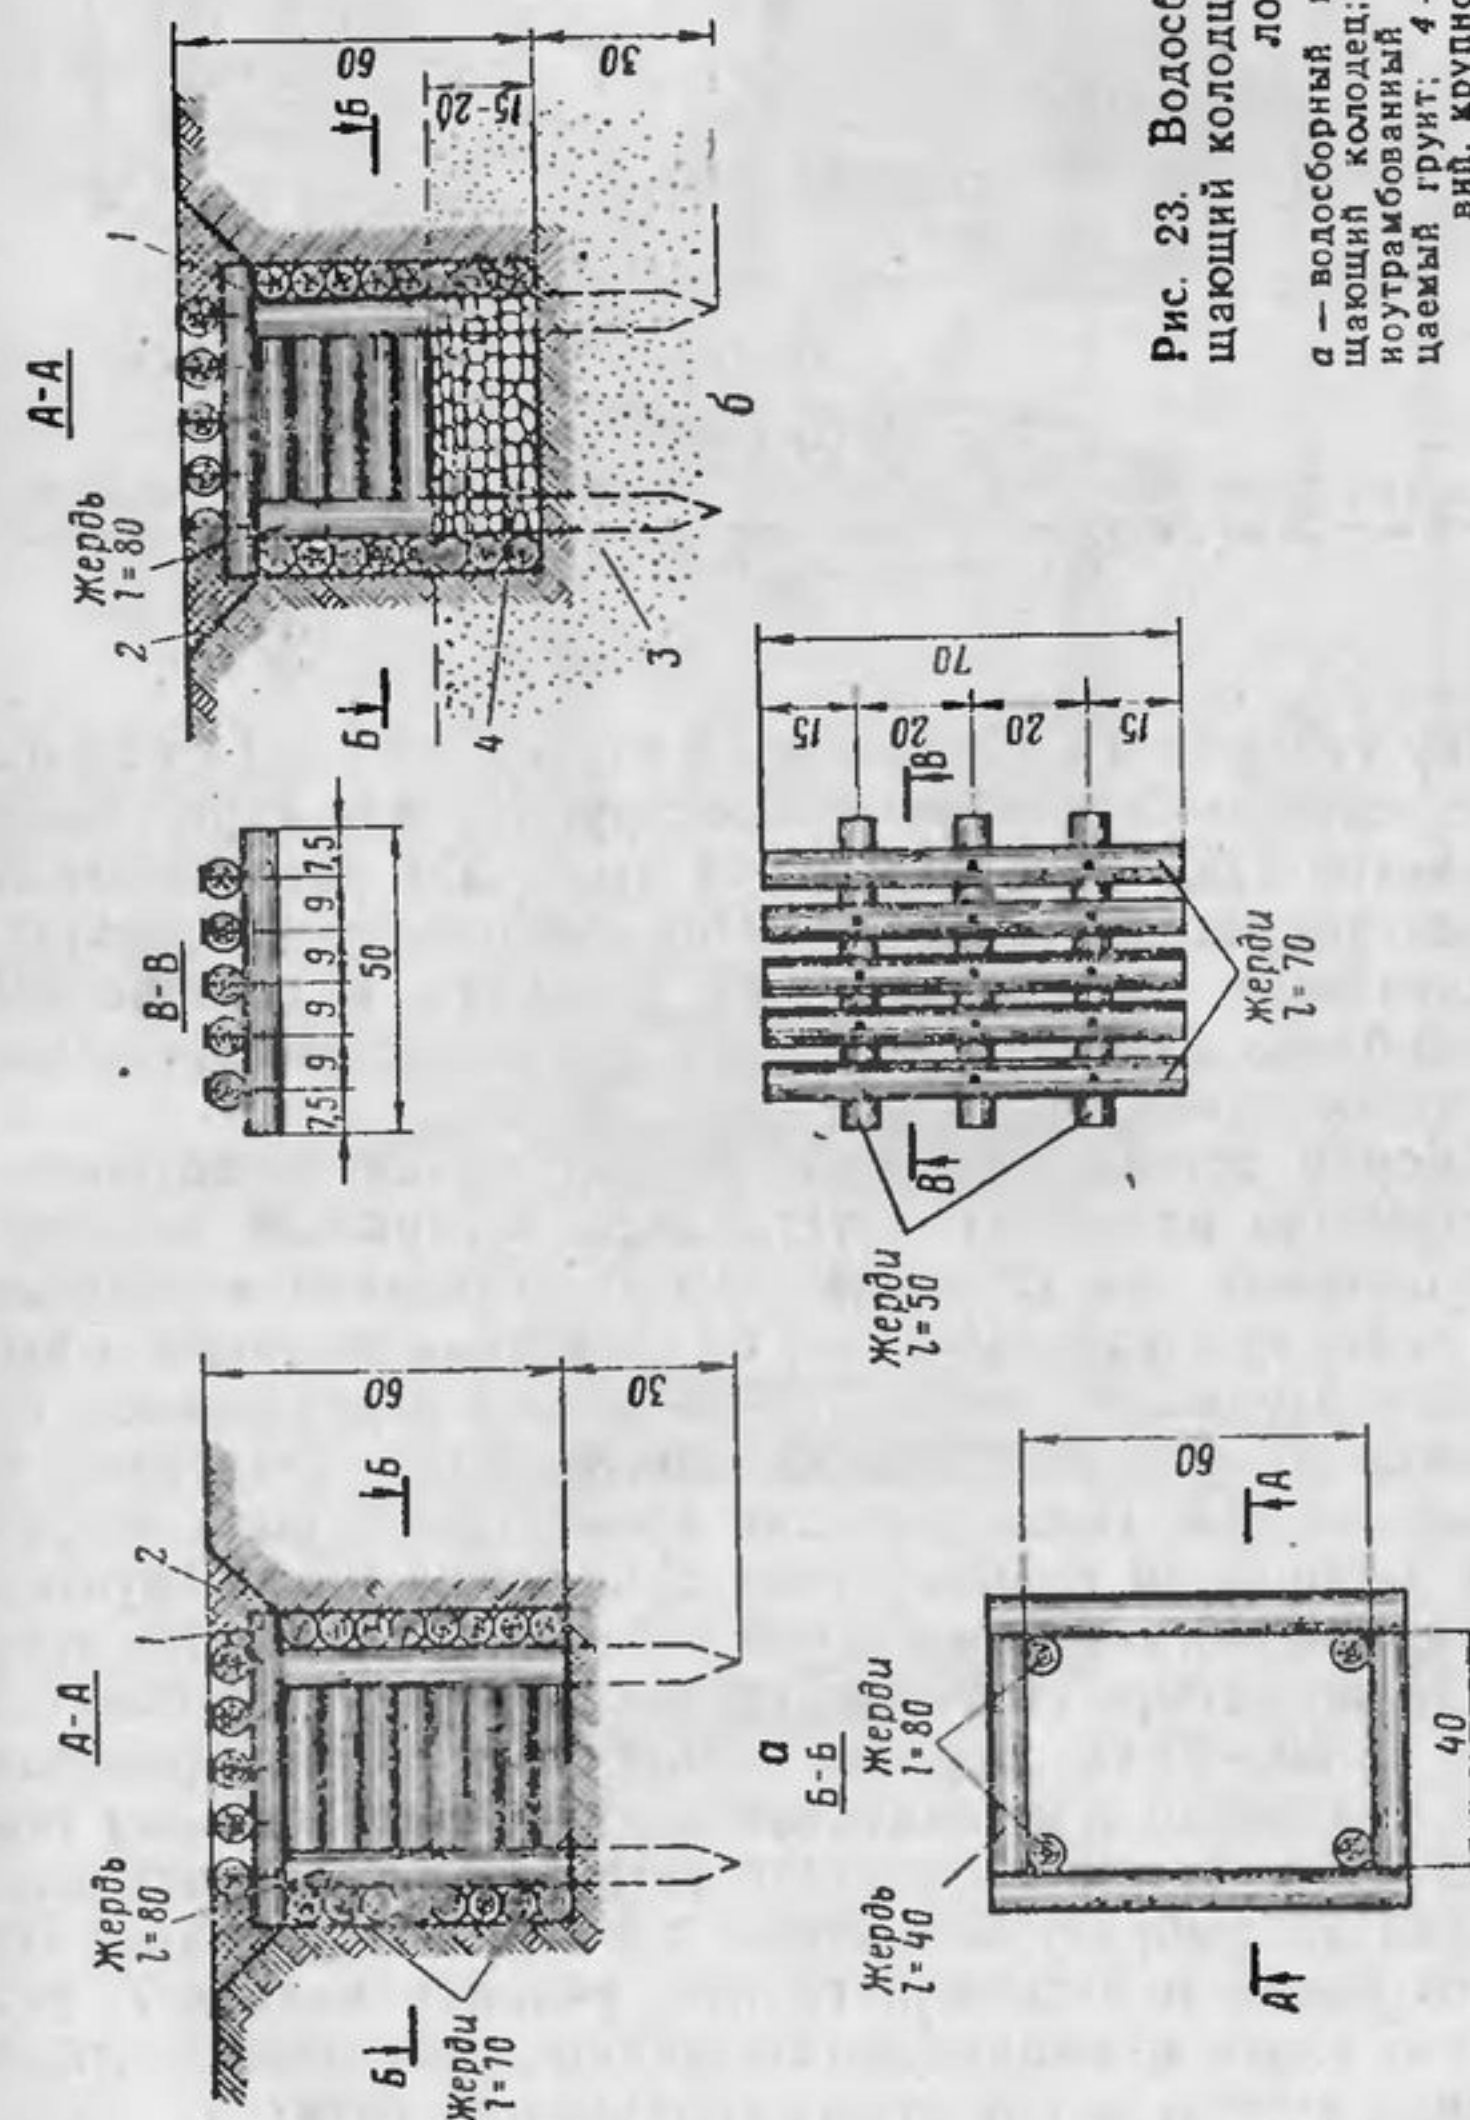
Водосборный и водопоглощающий колодцы с одеждой из круглого леса:
